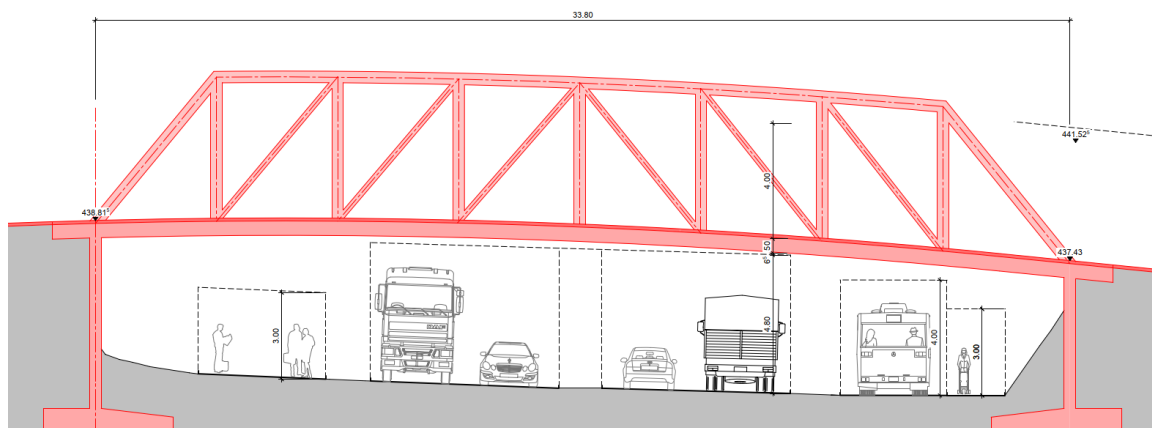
, Planausschnitt: Variante Fachwerk, Florian Sutter
